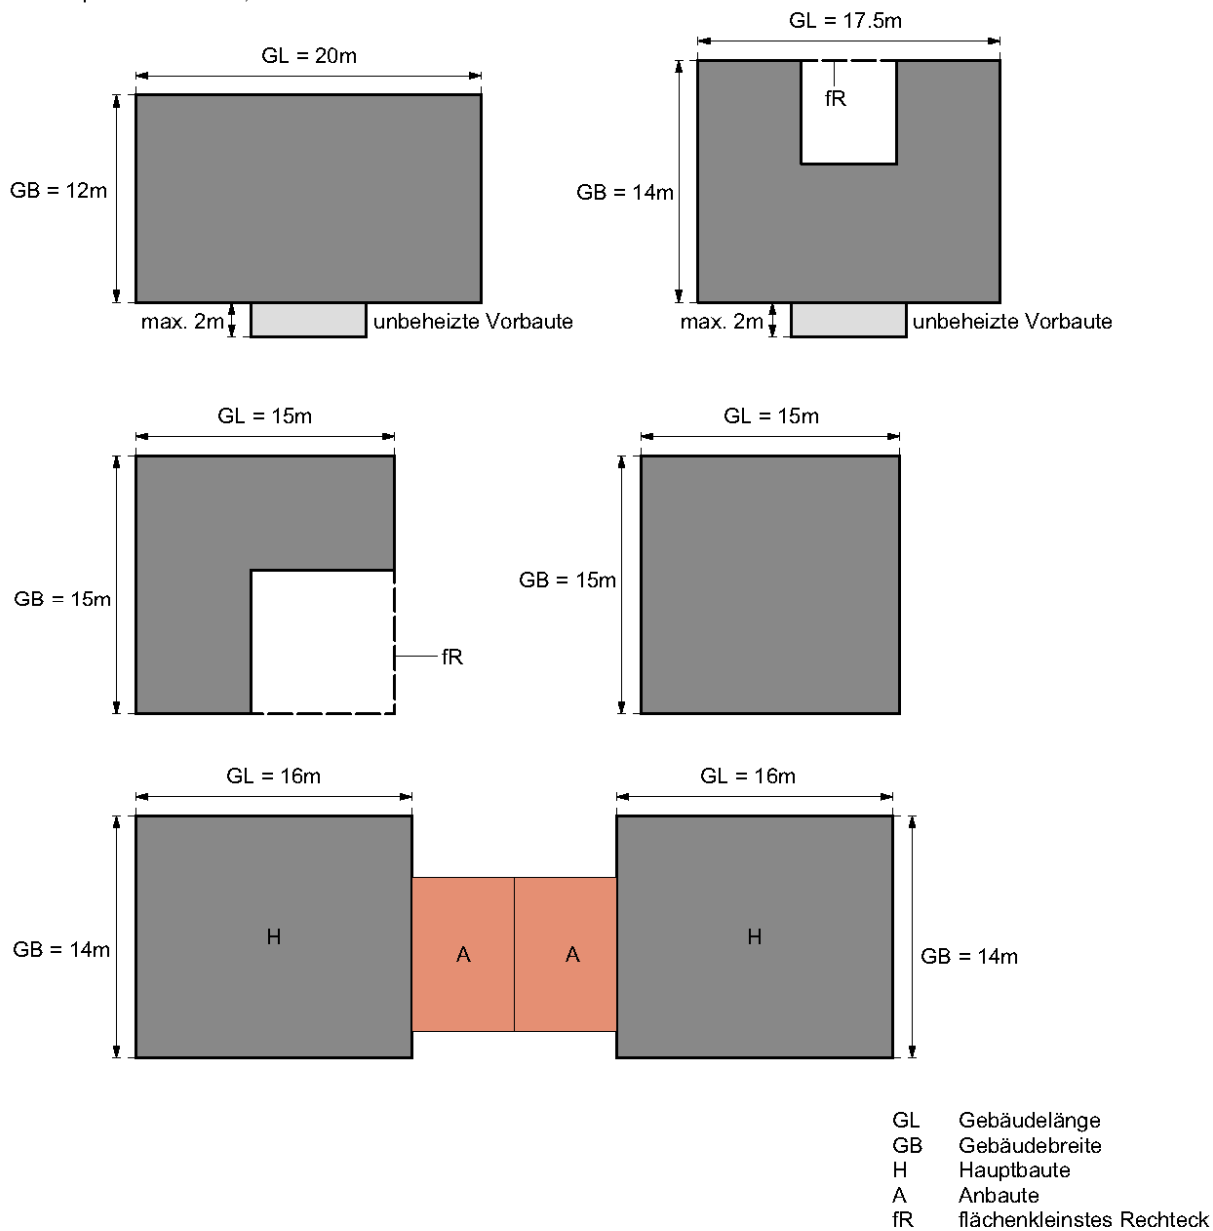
Flächenkleinstes Rechteck, Gebäudelänge, Gebäudebreite
